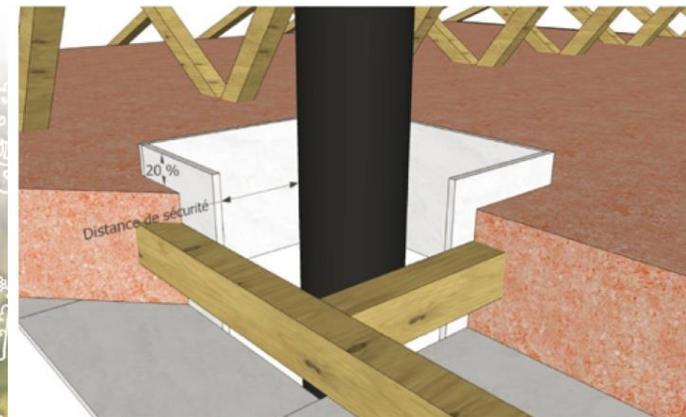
Distance de sécurité autour d'un conduit de fumée
